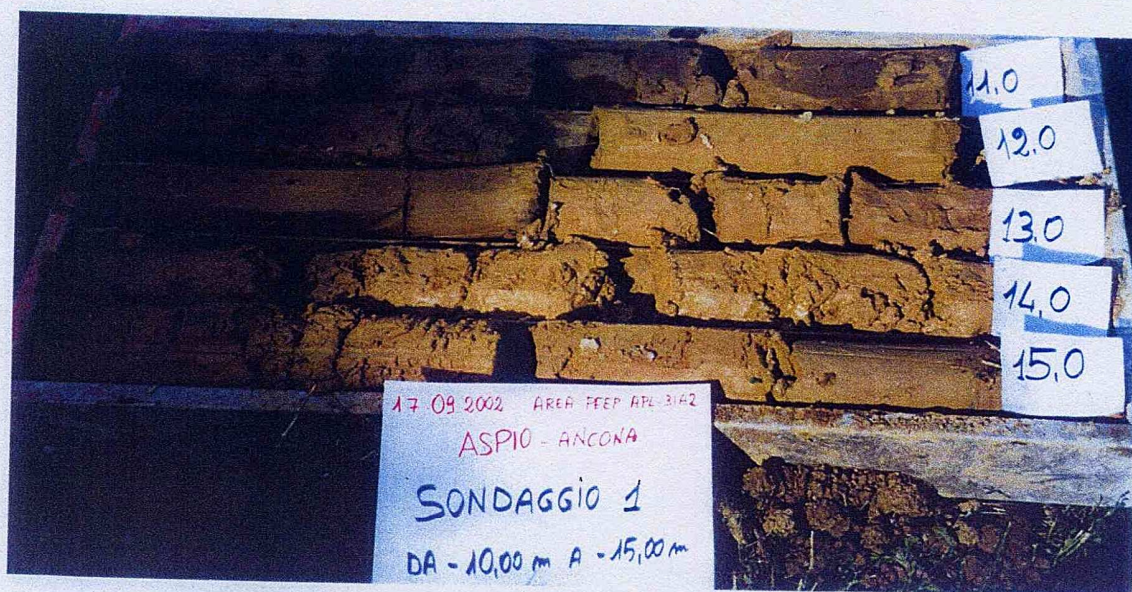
Sondaggio S.1 da -10,0 m a - 15,0 m da p.c.
